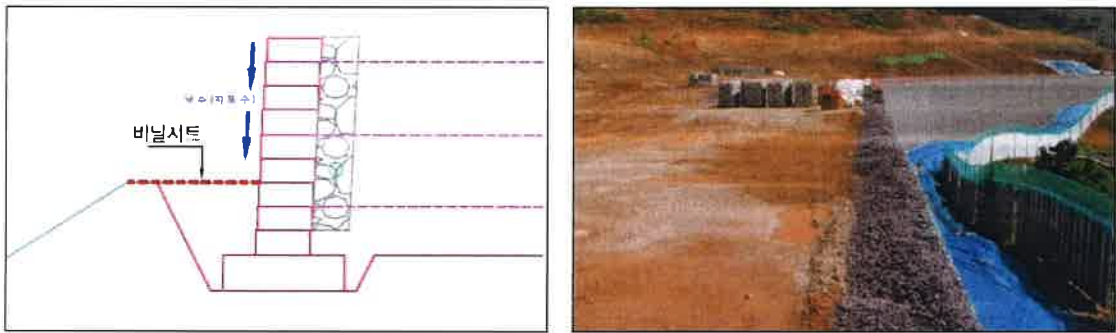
시공 중 기초 지반 세굴방지 임시비닐 Sheet설치 예
